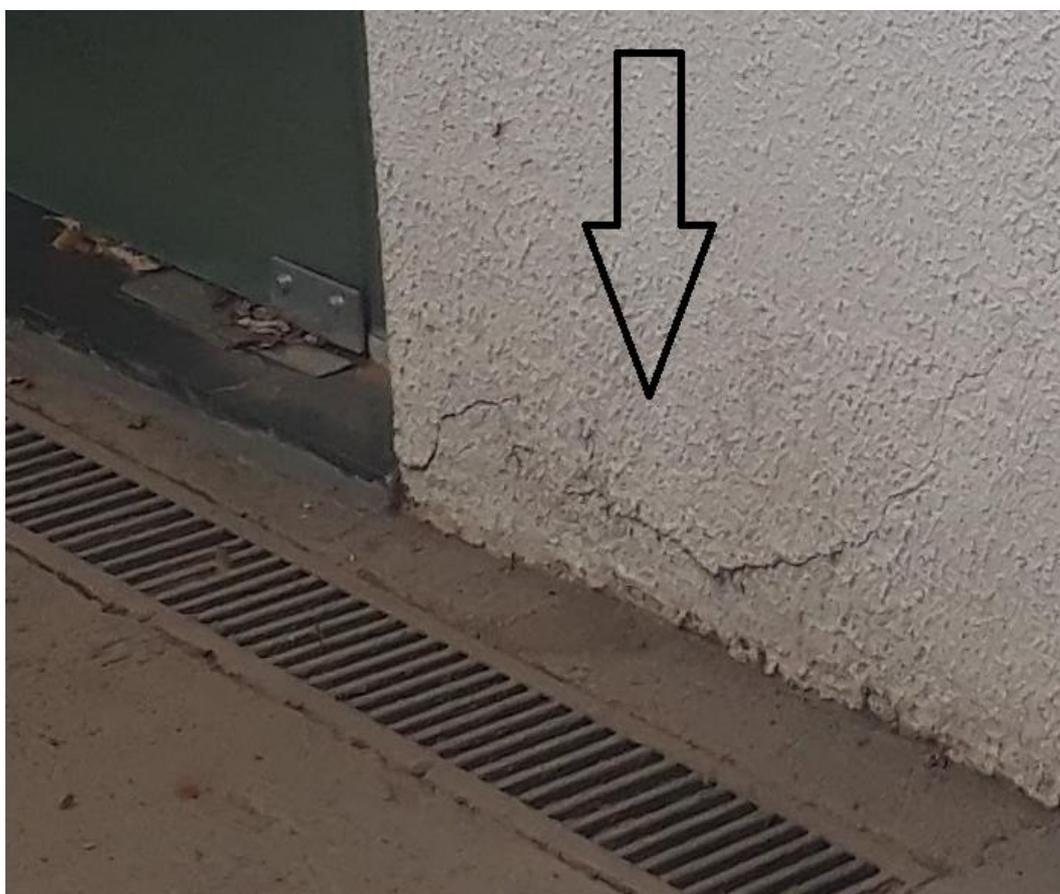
e 4 – data 18/10/2021 Fachada externa - Fissuras horizontal reboco/emboço apresentando deslocamento e pulverulencia (esfarelamento / massa podre) ao longo na parte inferior da parede, provocada por umidade percolante (capilaridade) de fora para dentro. Sua possível causa em decorrência a falta de desnível e impermeabilização latera à grelha de escoamento pluvial.
